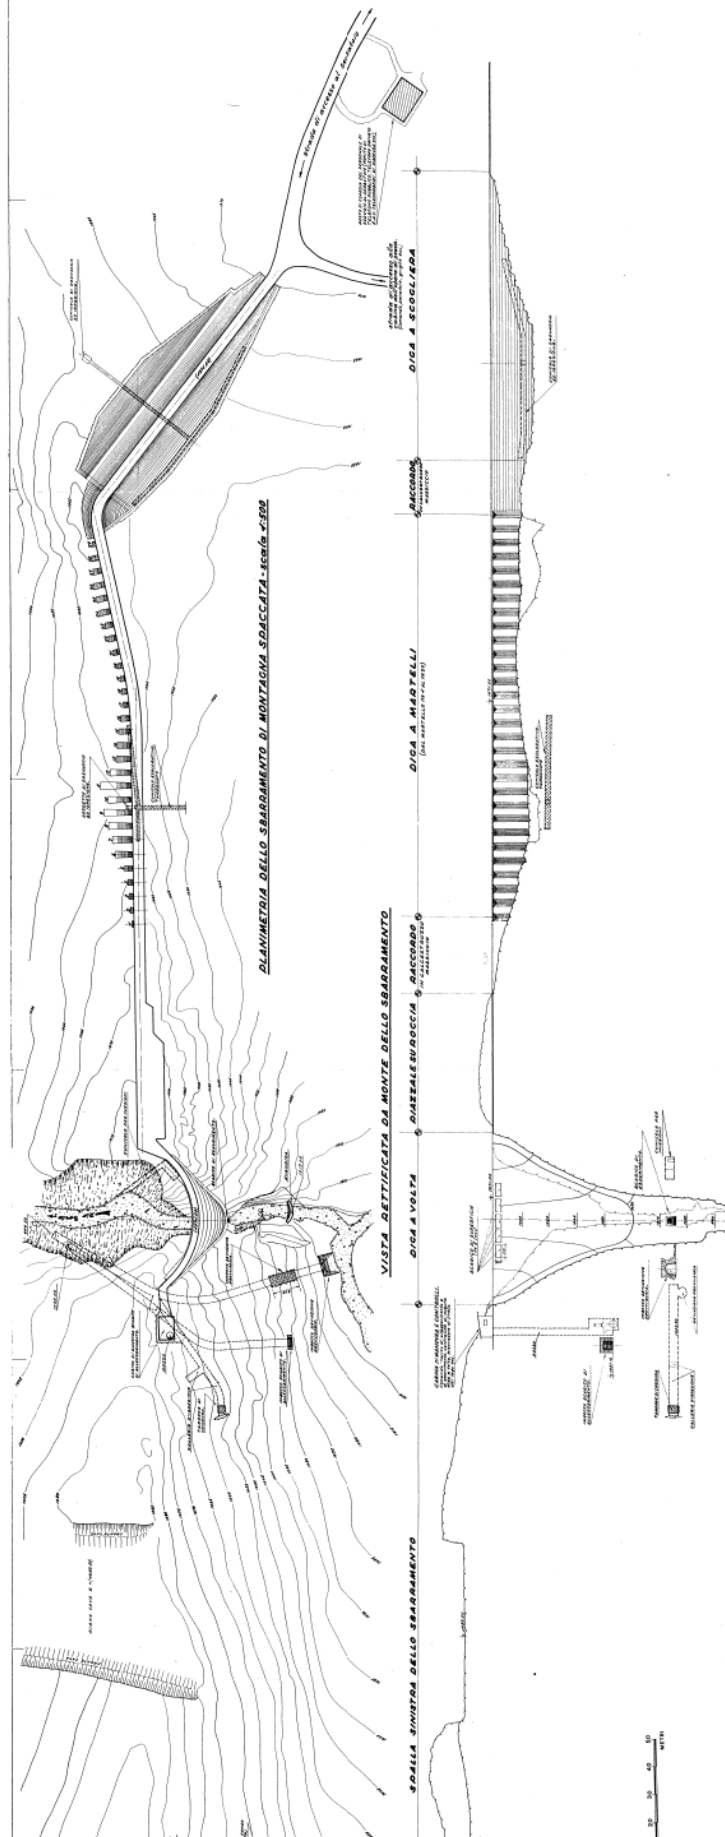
planimetria (sopra) e profilo longitudinale (sotto) della diga principale
